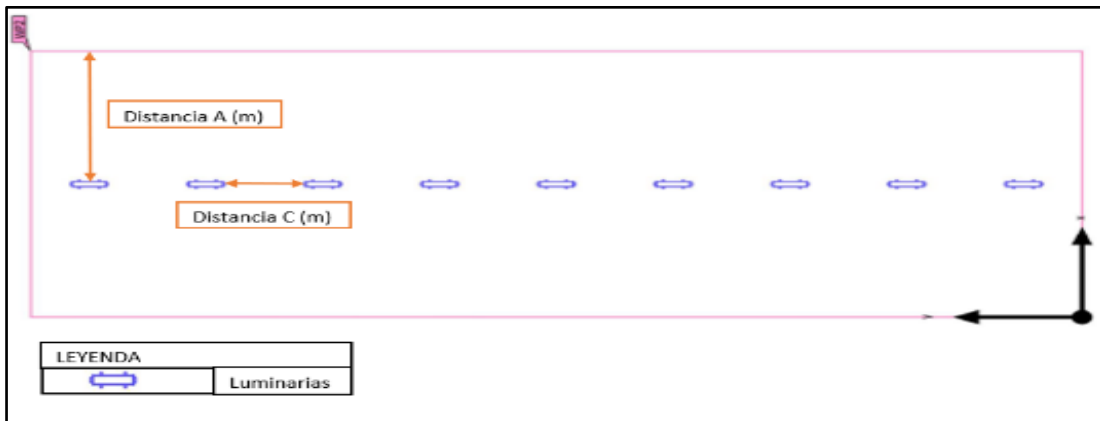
Vista de planta de los detalles de distancias entre luminarias
